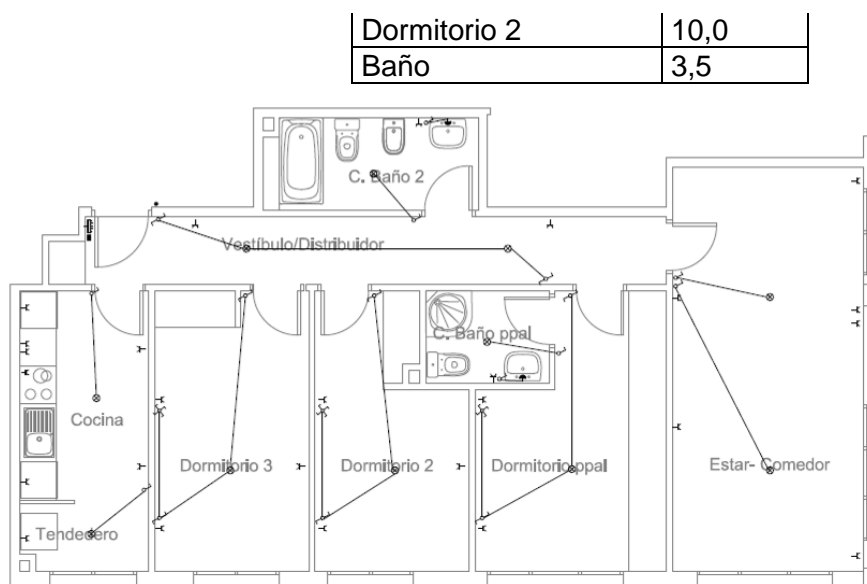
Plano de la vivienda tipo, para el cálculo del coste de reforma
